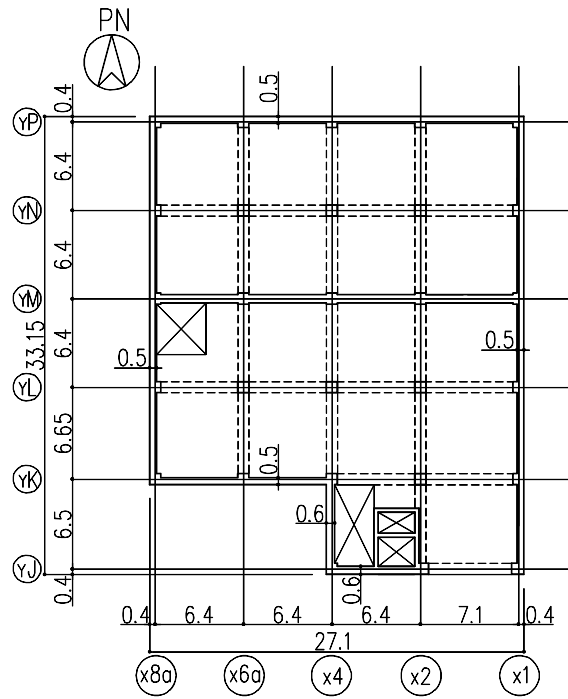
地下1階平面図 (G.L. -4.2) (单位 : m)
